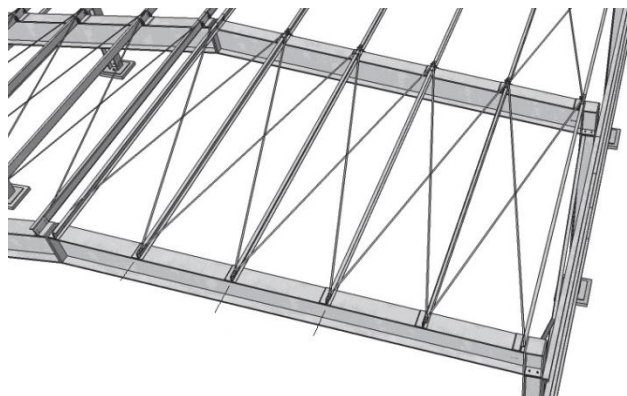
Contraventamento horizontal no plano da cobertura (Pravia *et al.*, 2010)
